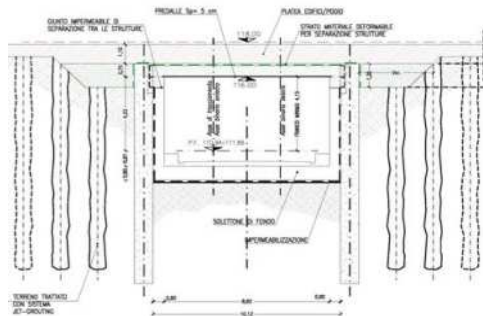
Sezione a "ponte" fondazionale ed. E2
